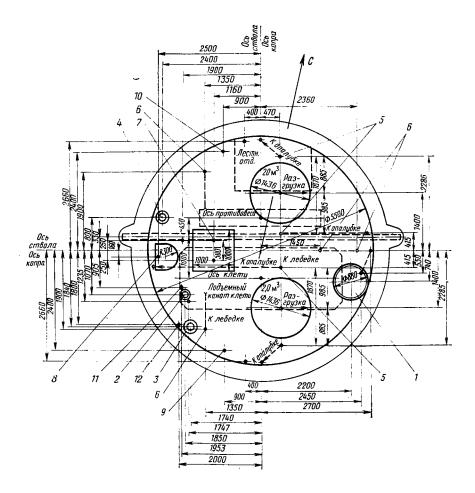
Схема расположения проходческого оборудования в поперечном сечении вентиляционного ствола при подвеске секционной опалубки на направляющих канатах:
